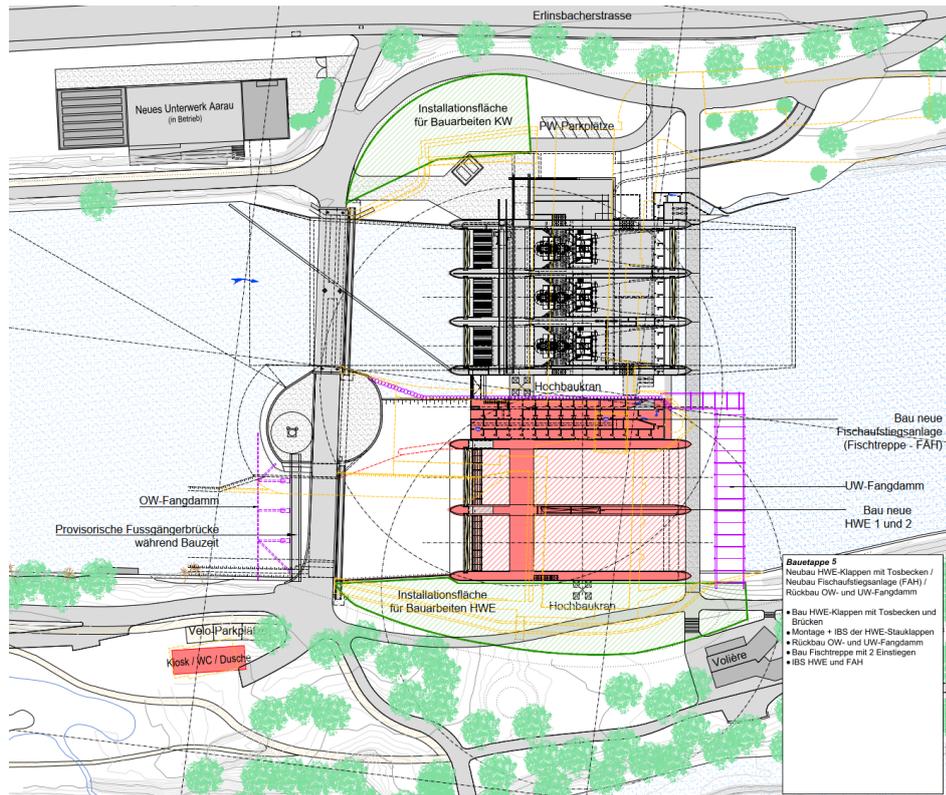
Bauetappe 5 – Bau neue HWE-Klappen / Erstellung Mittelblock mit Fischaufstiegsanlage
